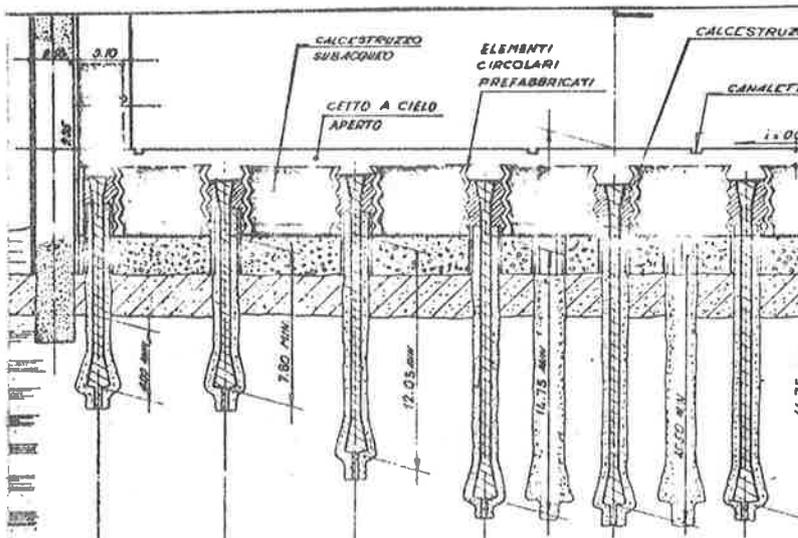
Schema della sezione della platea con i pali di fondazione.
